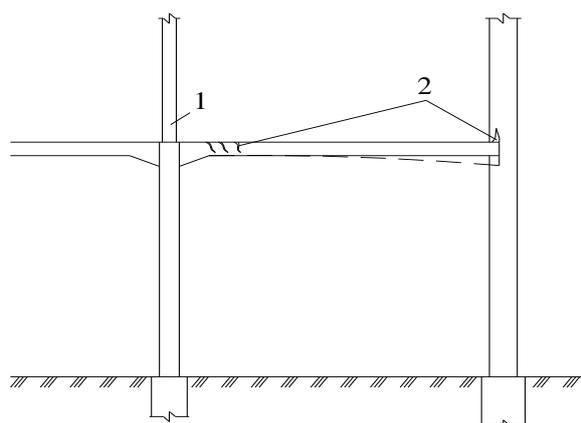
Образование трещин в железобетонном прогоне и кладке оттаивающей стены:
